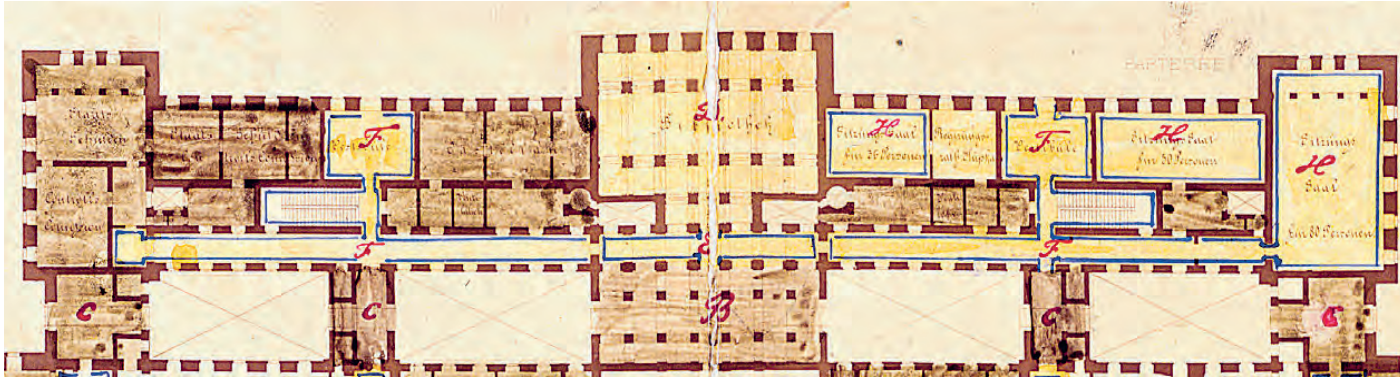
Theophil Hansen, Planausschnitt, Grundriss Parterre mit Angaben zur Herstellung von Wand und Plafond, 1880.
